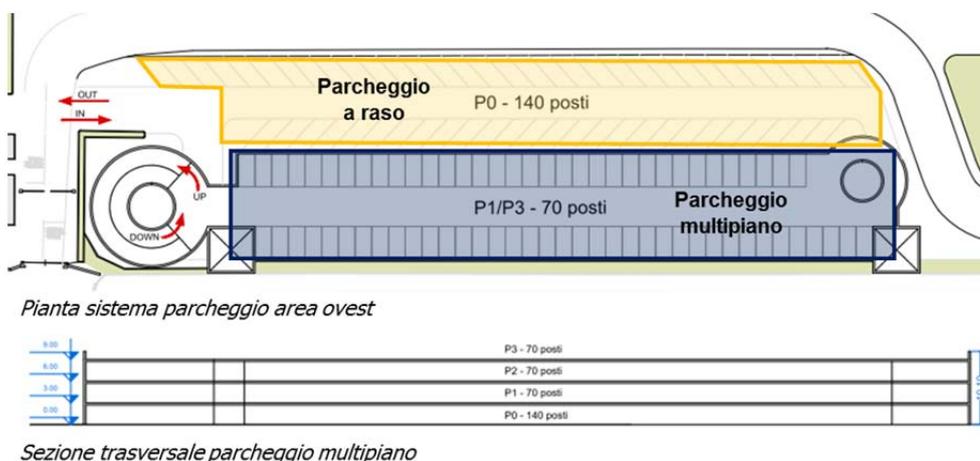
Sistema parcheggi: parcheggi area ovest, pianta e sezione trasversale
